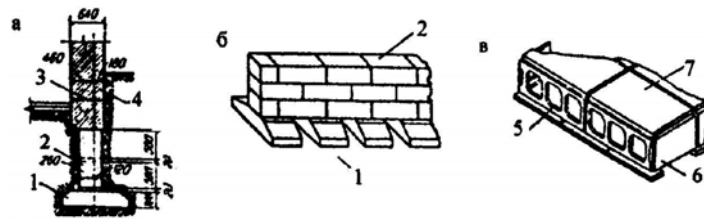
Збірні бетонні стрічкові фундаменти:
